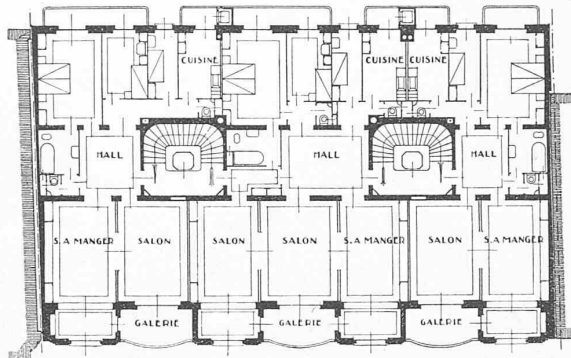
Grundriss eines Obergeschosses des Miethauses „Splendid Rivage“ in Genf. — Masstab 1 : 400.
